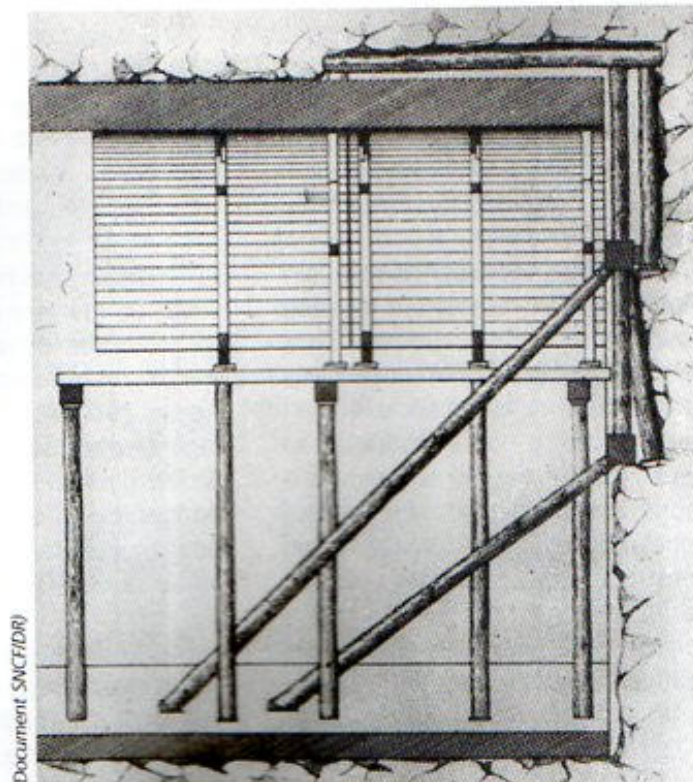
Coupe longitudinale, Tunnel de La Nerthe
